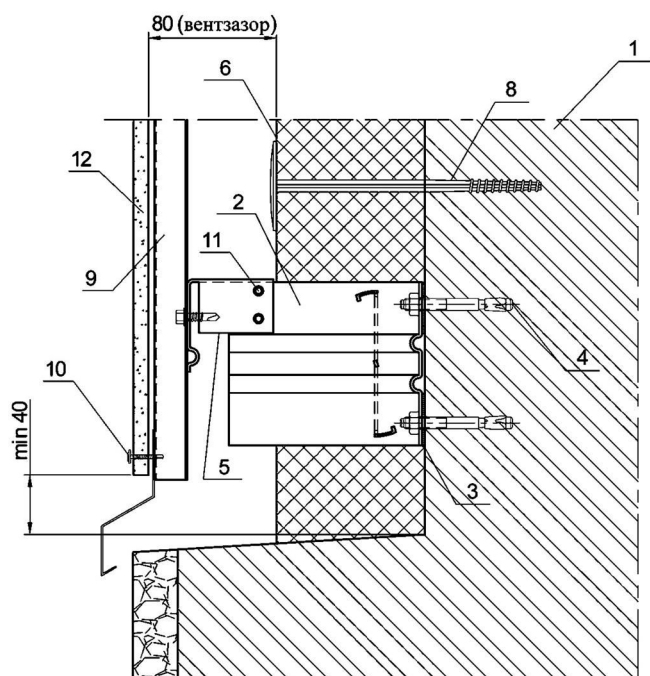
Внешний угол здания. Разрез Ж-Ж (вентфасад)
